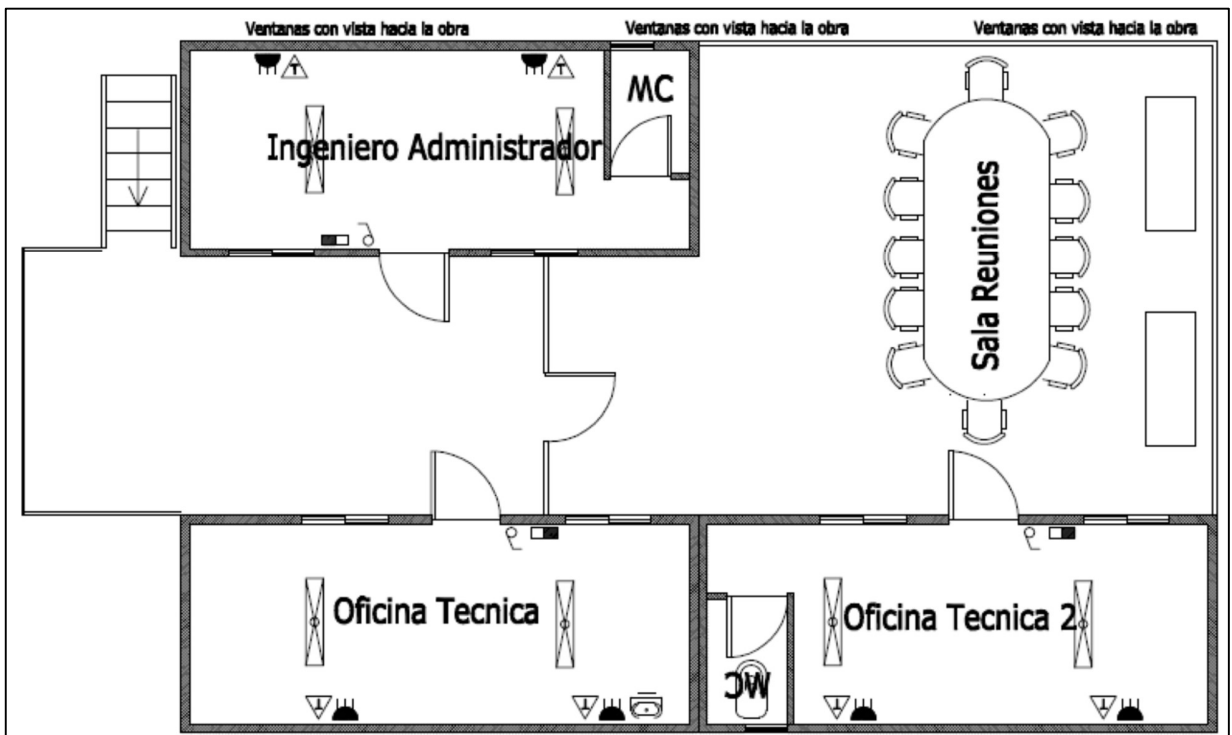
DETALLE INSTALACIÓN DE FAENA SEGUNDO PISO
